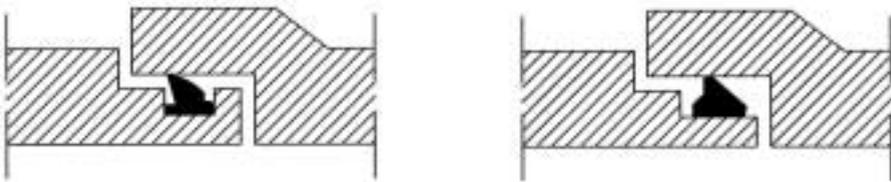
Uniones flexibles con extremos en enchufe y campana en los tubos de hormigón.
